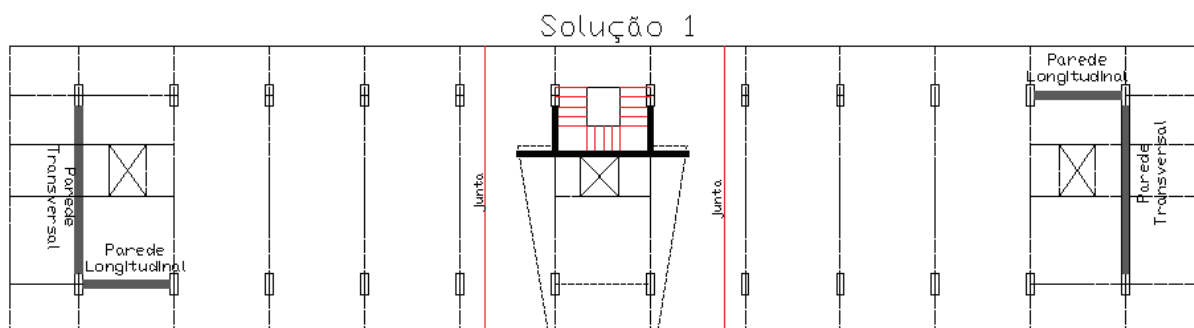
Disposição em planta da localização da implantação das paredes resistentes para a solução 1- Edifício Lisboa.
